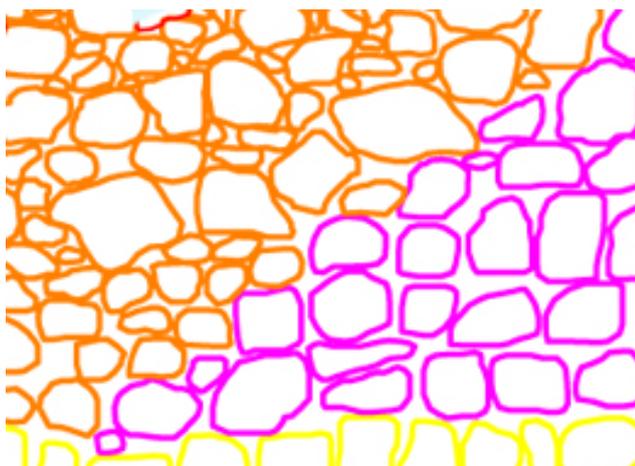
Pormenor U4. Levantamento arquitectónico (zona C). JMM
